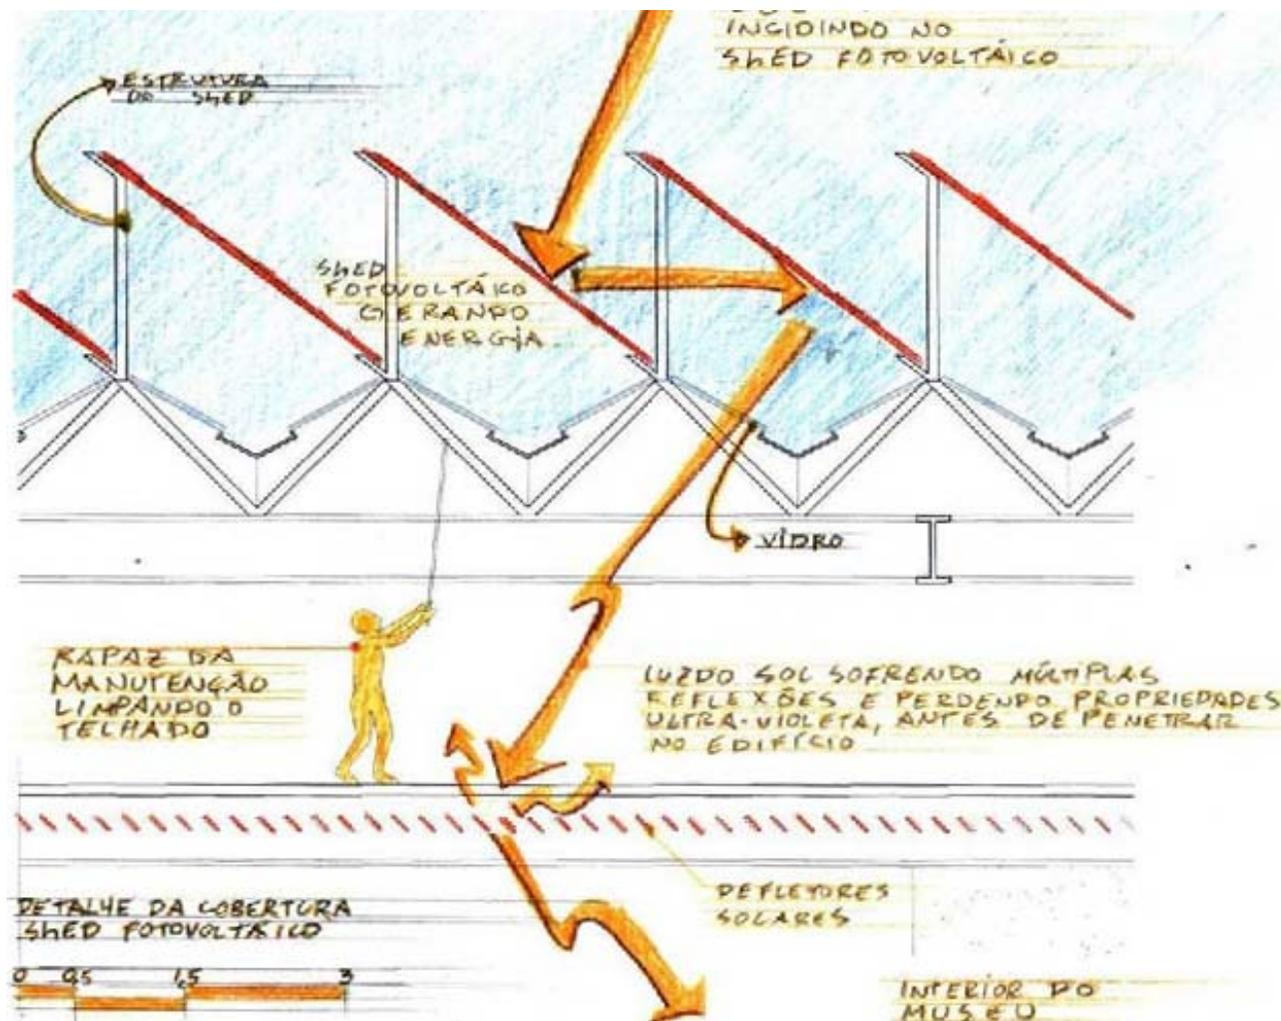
Detalhe da cobertura - shed fotovoltaico. Fonte: concepção Márcio Porto, 2004.
